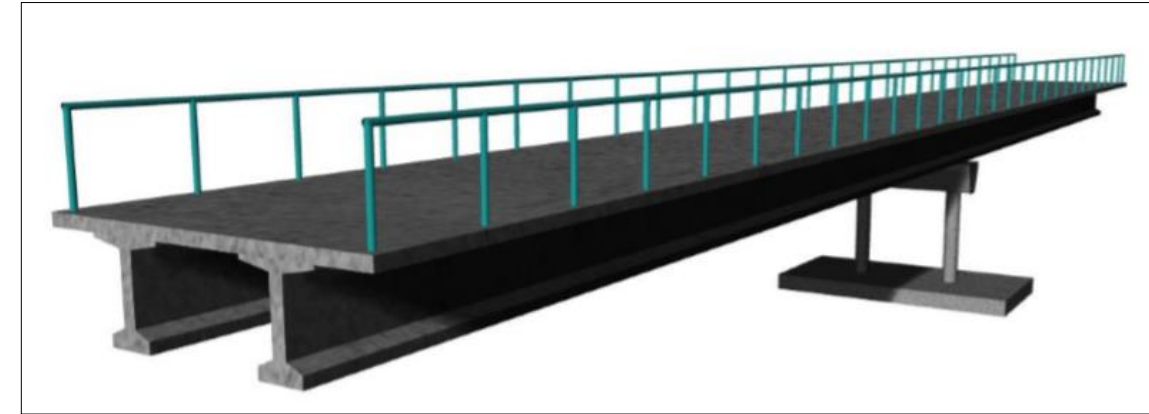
Solución de vigas de hormigón prefabricadas bajo losa de hormigón. (Fuente: [http://oa.upm.es/52539/1/TFM\\_OSCAR\\_MOMPART\\_PINTO.pdf](http://oa.upm.es/52539/1/TFM_OSCAR_MOMPART_PINTO.pdf))
